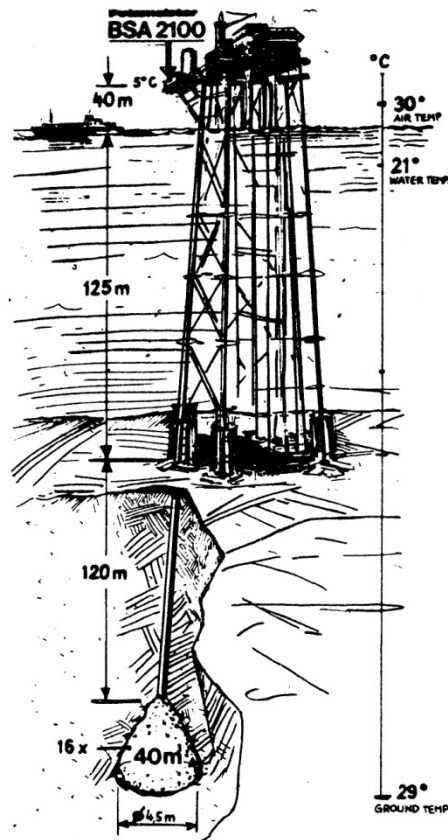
Усиление свай платформы: 1 — свая; 2 — бетонное подкрепление
